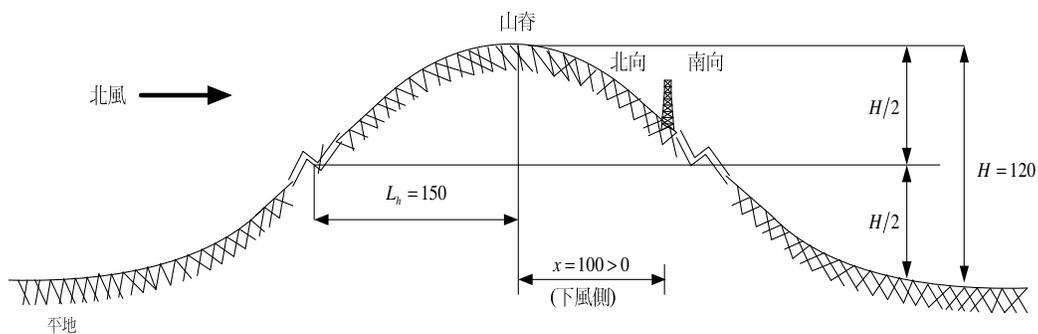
獨立鐵塔西向與附近地形的立面示意圖 單位 (m)
